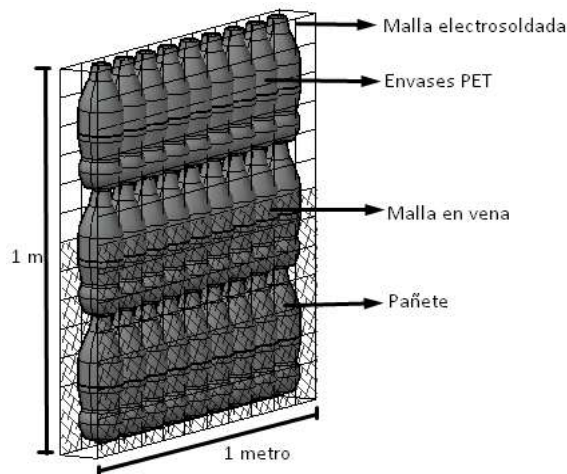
FIGURA. X MODELO MURO NO ESTRUCTURAL CON ENVASES 3 LITROS
